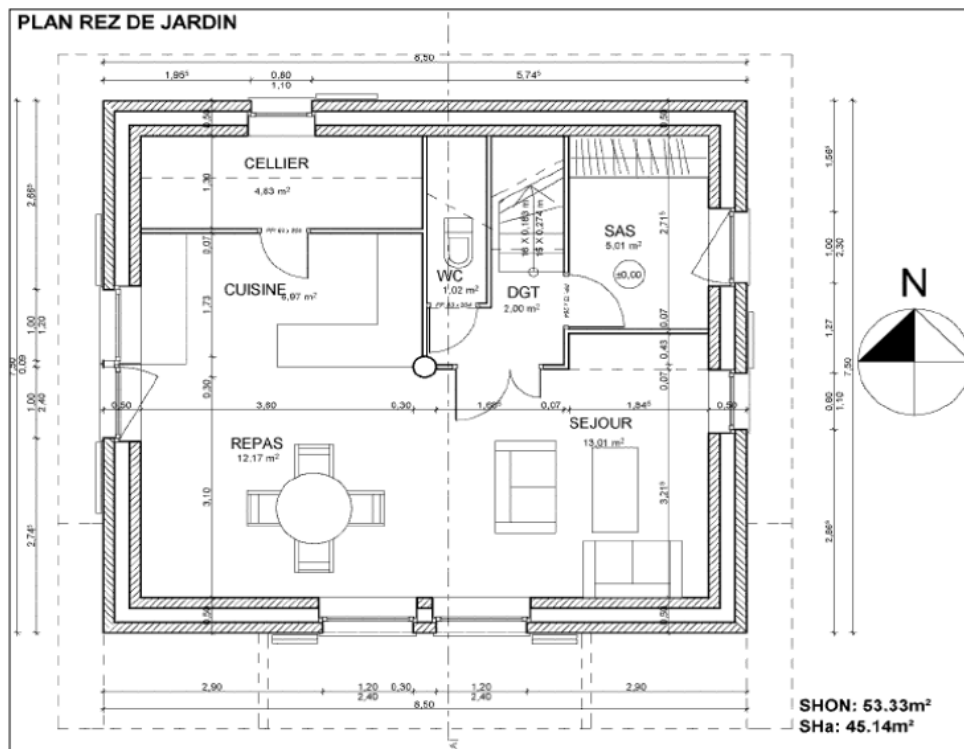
plan du rez-de-chaussée de la maison I-DM
